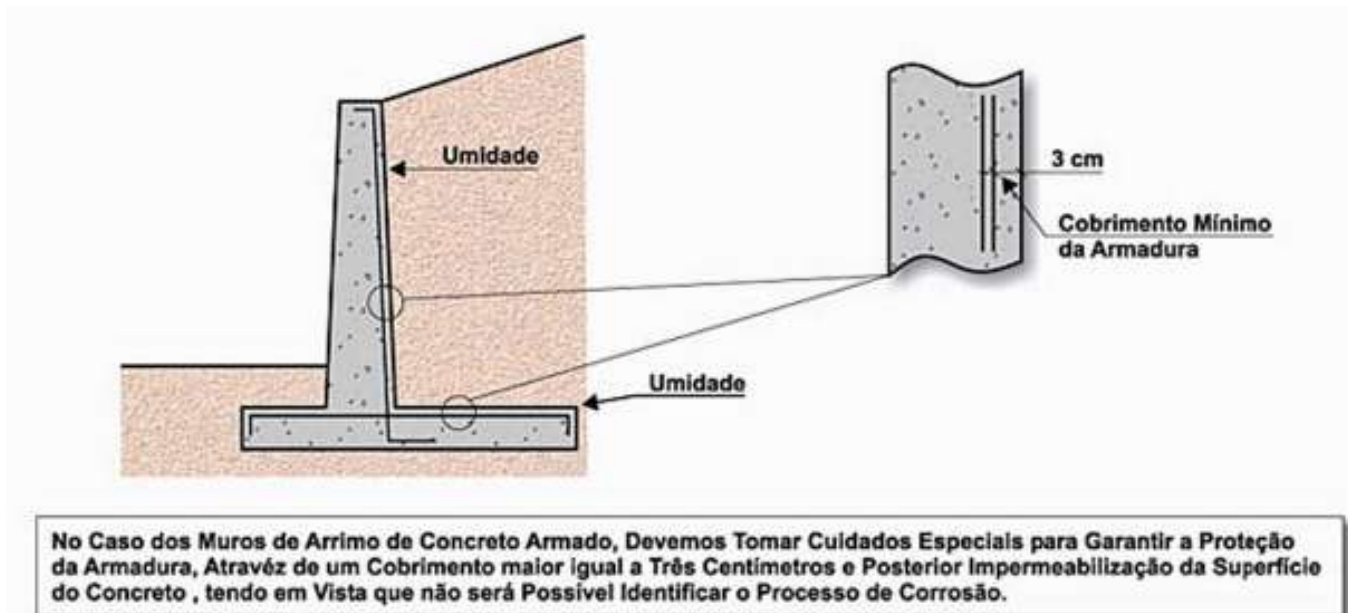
Cobrimento da ferragem em muro de arrimo
